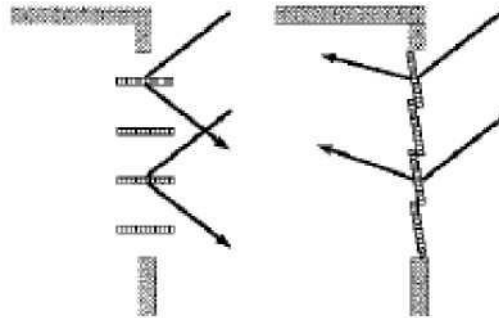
Lazer Kesim Panellerin Kırılma Bakımı İle Gün Işığı Arasındaki İlişki
